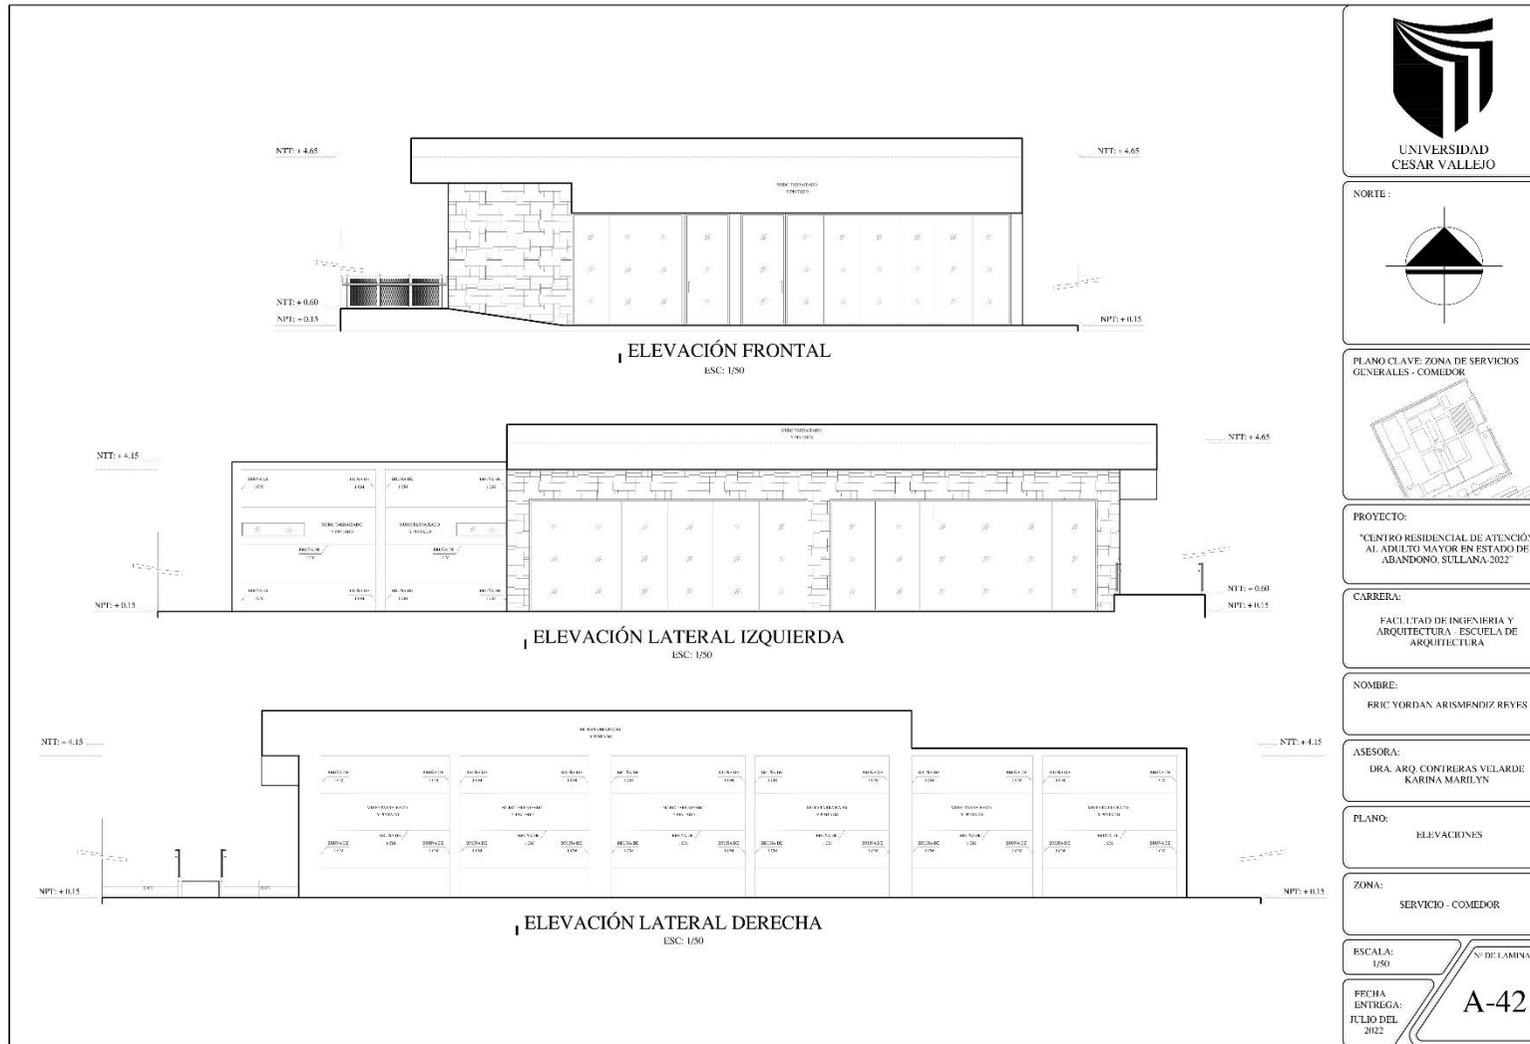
Plano de zona de servicio-servicio elevaciones A – 46
